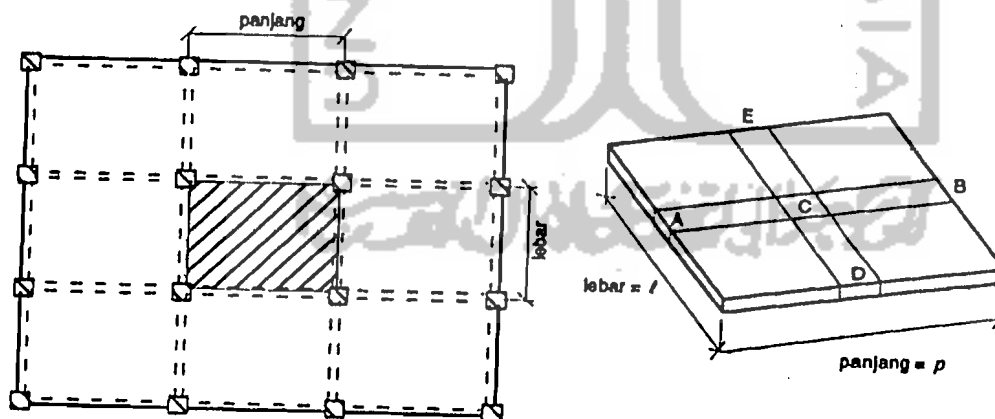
Pemotongan Vertikal Denah Bangunan
